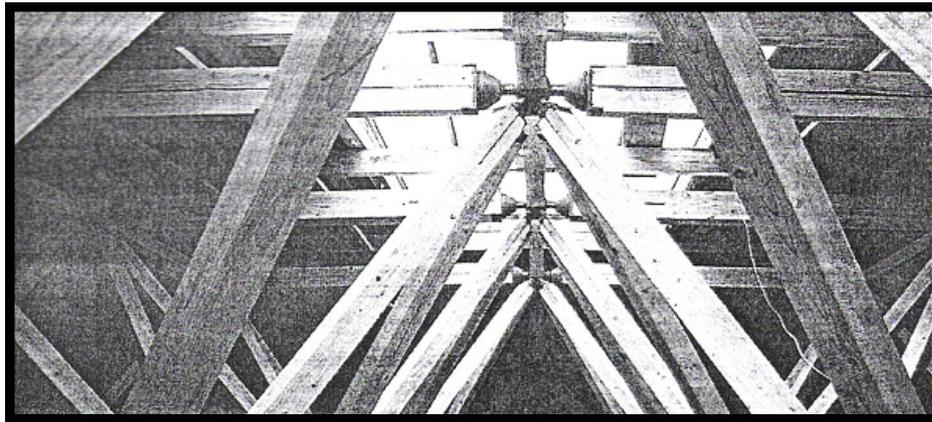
Exemplo de ligações em estruturas articuladas espaciais
